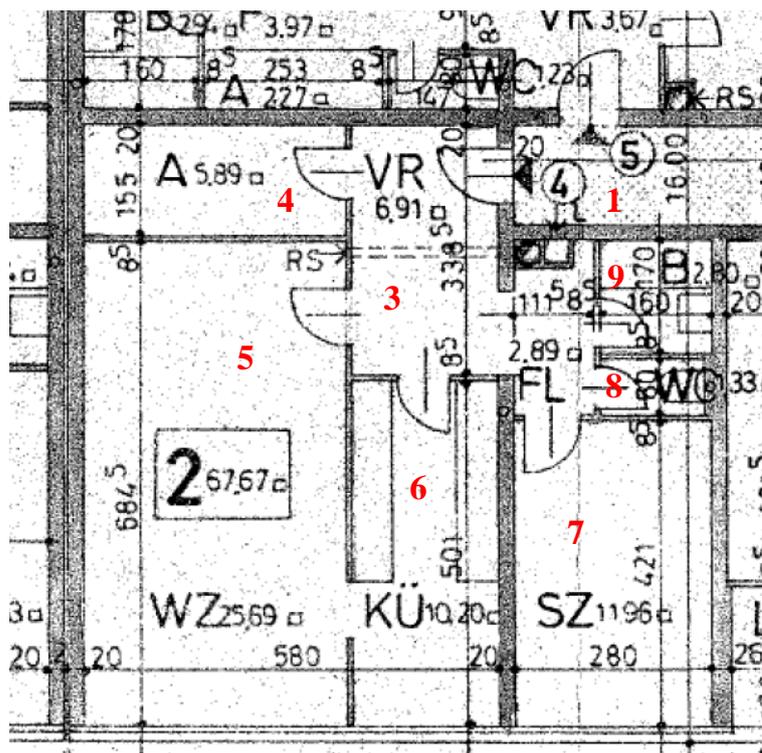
Grundriss Top W43/2/1; Quelle: Bestandsplan Dezember 1971 o. M.
